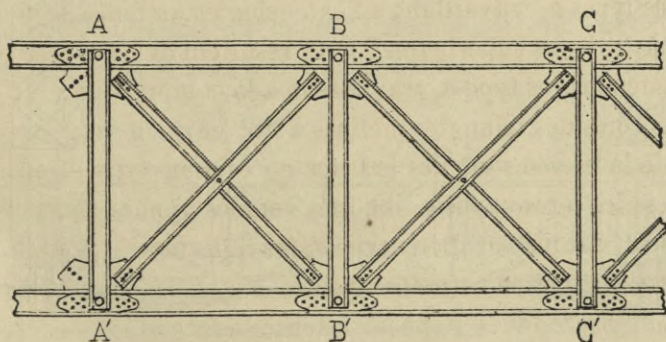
Élévation d'une poutre principale du pont de 33 mètres ($\frac{1}{112}$) [type n° 1].
